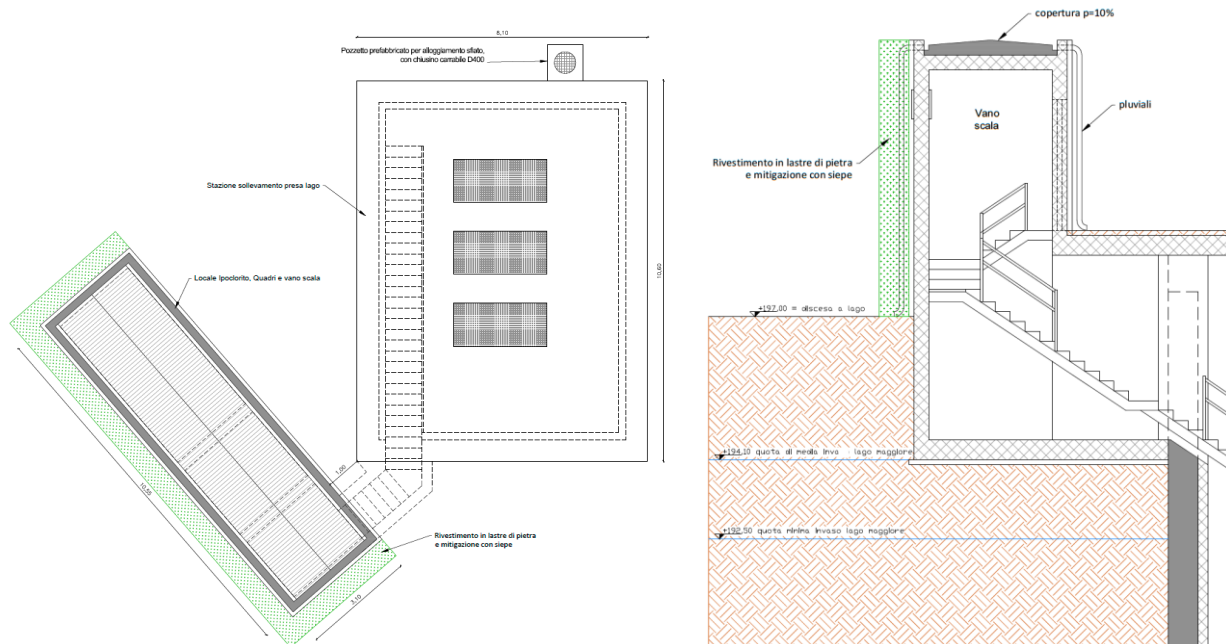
Nuovo edificio tecnico – Pianta e sezione.
